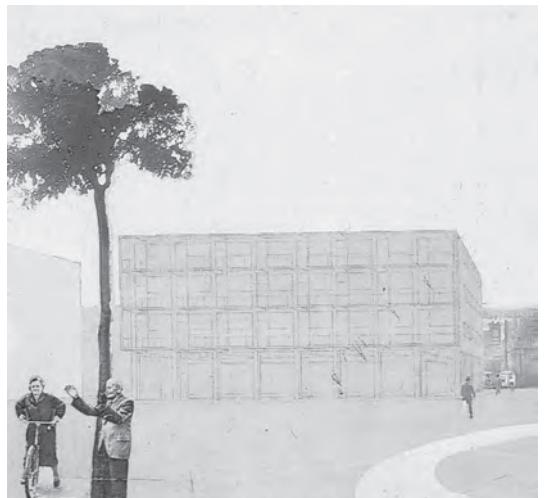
Bottoni. Progetto di palazzi in Piazza Fontana, 1952-55. Collage prospettico (part.). Milano, APB.
